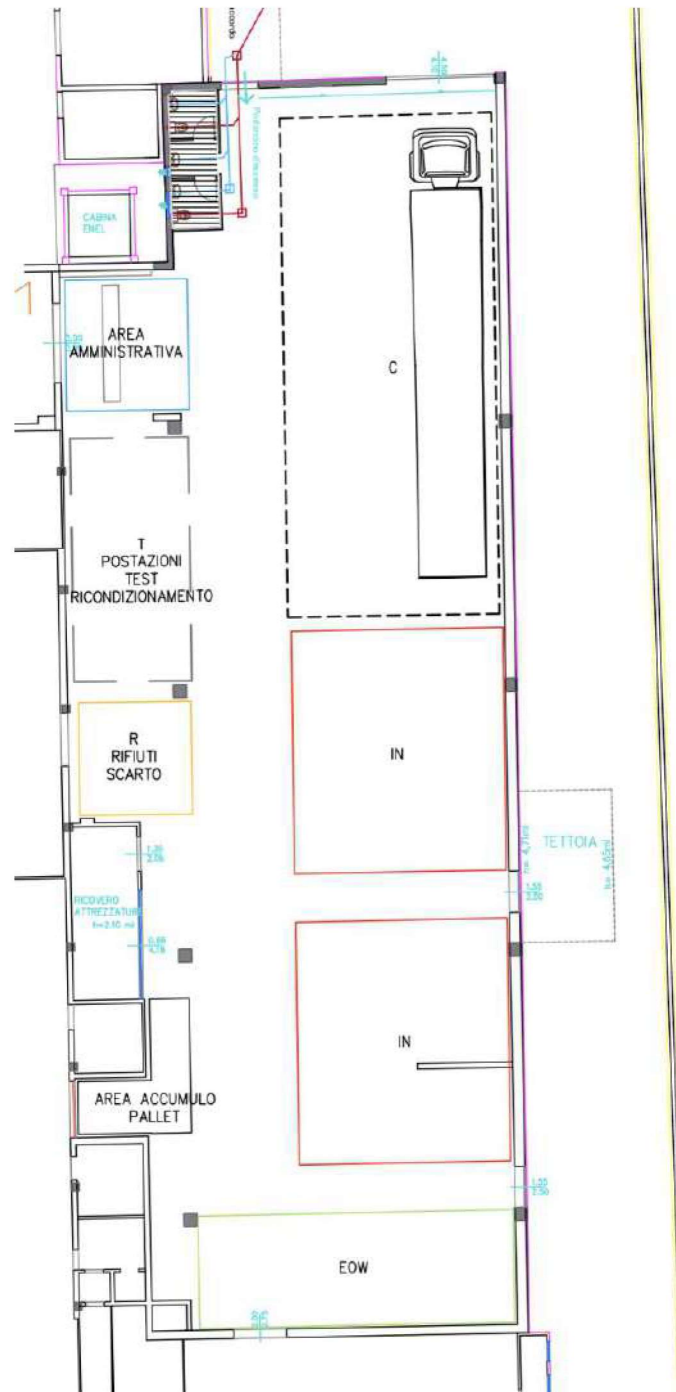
Estratto dell'elaborato grafico Tavola n. A3.8 "Planimetria Layout delle aree"
